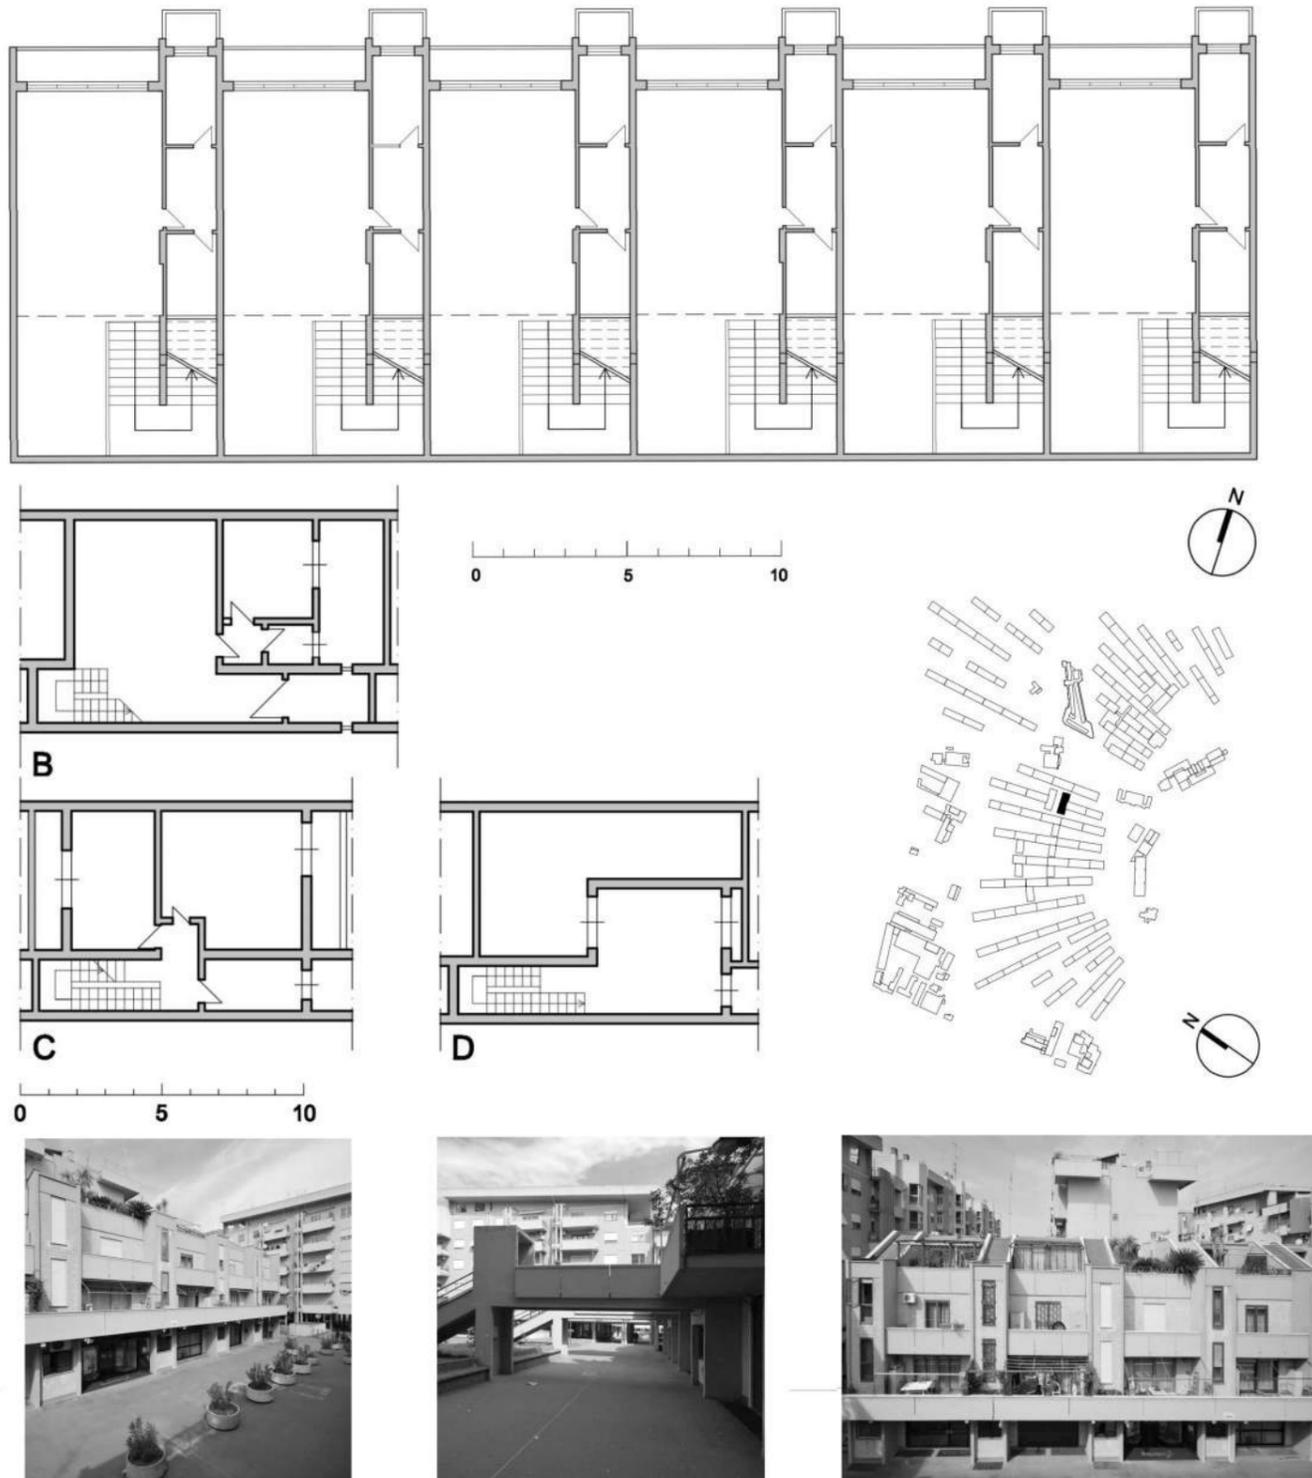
Cooperativa a.r.l edil "le muse"; edificio a ballatoio, fabbricato "T5"; A - pianta negozi; B - pianta piano primo alloggio "C"; C - pianta piano secondo alloggio "C"; D - pianta piano terzo alloggio "C"
